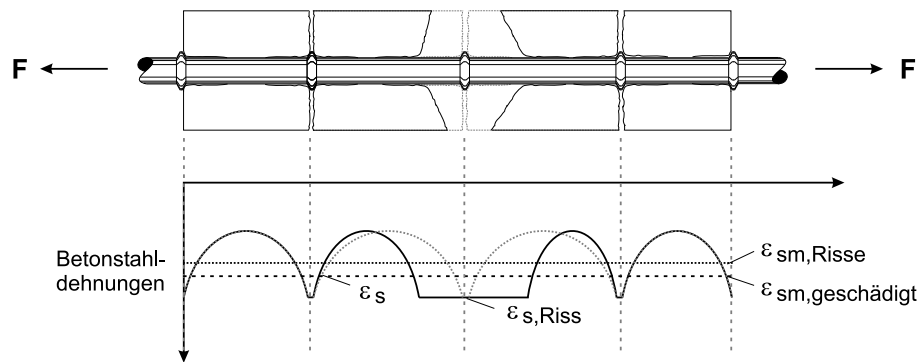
Entwicklung der Betonstahldehnungen im Riss $\epsilon_{s,Riss}$ und der mittleren Betonstahldehnungen ϵ_{sm} bei Freilegung der Bewehrung und Schädigung des Verbunds zwischen Beton und Betonstahl
